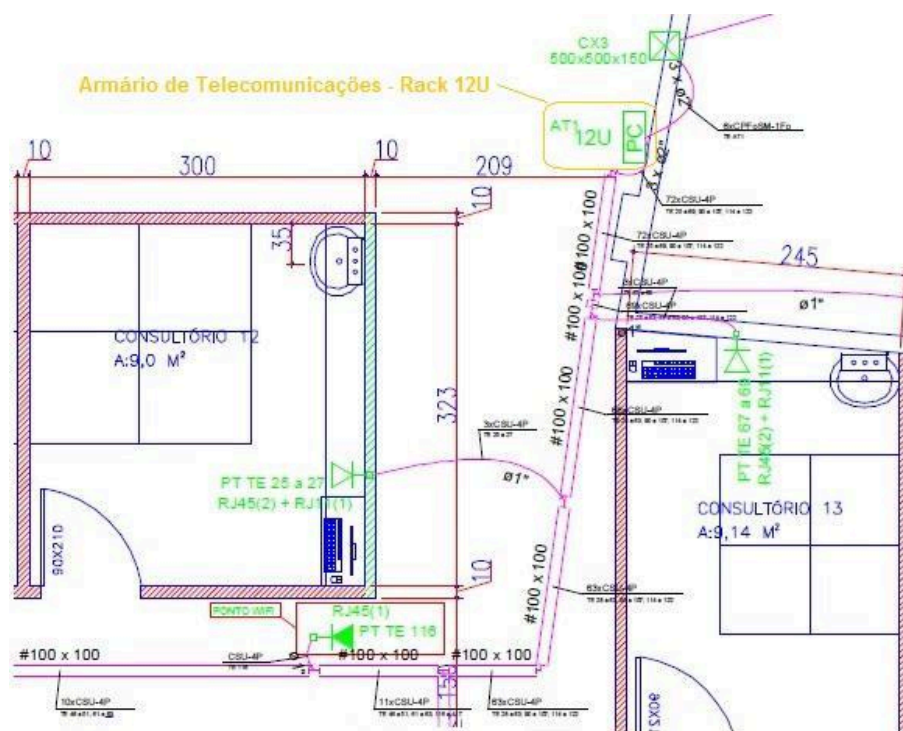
Detalhe da localização do *rack* de 12U projetado para o pavimento térreo
